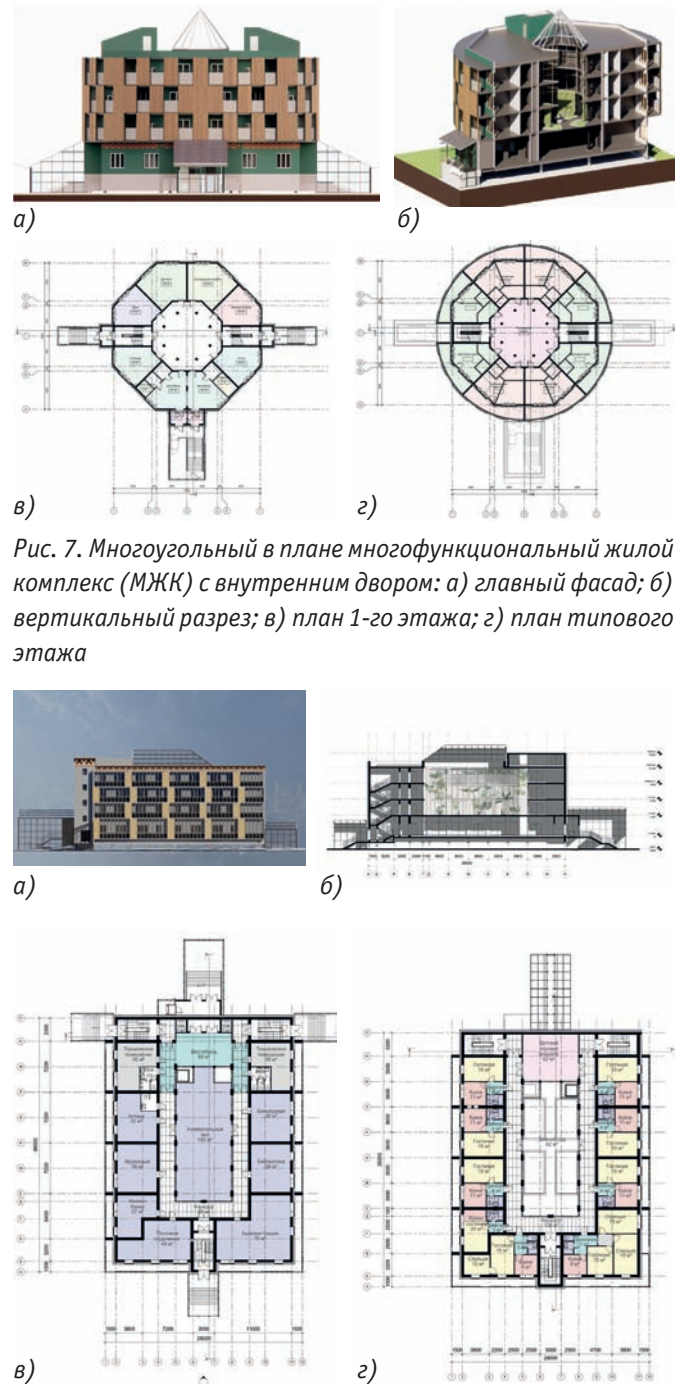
Многоугольный в плане многофункциональный жилой комплекс (МЖК) с внутренним двором: а) главный фасад; б) вертикальный разрез; в) план 1-го этажа; г) план типового этажа
